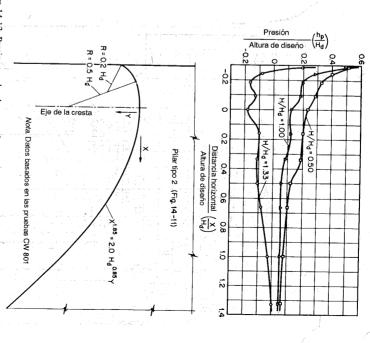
Presiones sobre la cresta de vertederos de rebose WES altos (continuación). (b) A lo largo de la línea central de un vano de pilares (U. S. Army Engineers Waterways Experiment Station [20], Hydraulic Design Chart 111-16/1, WES 3-55).
